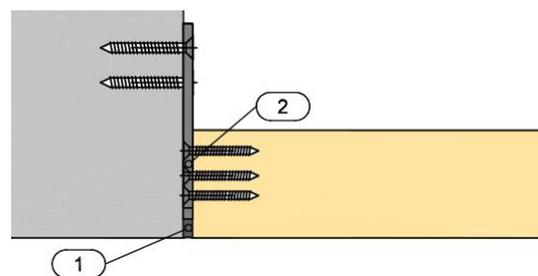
mit Stahl U-Profil 30 x 14 / 3
